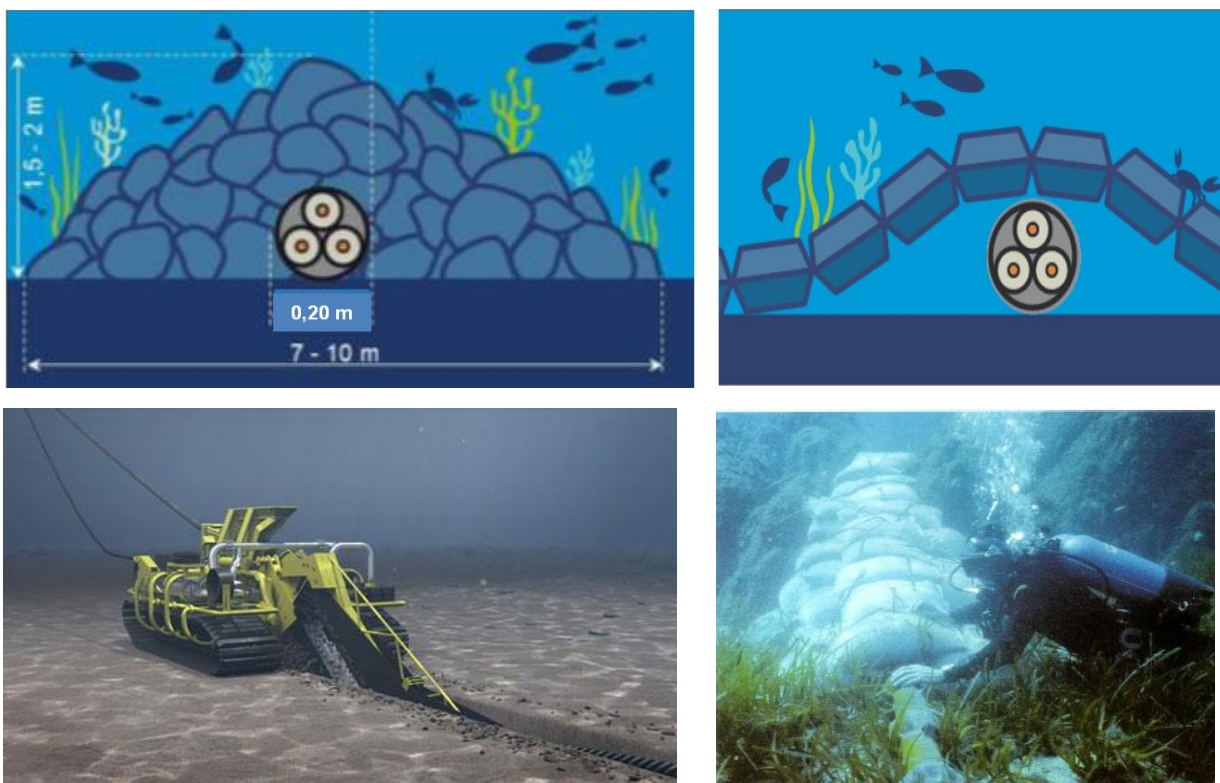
Esempio di cavi posati sul fondale e sistema di protezione dei cavi
